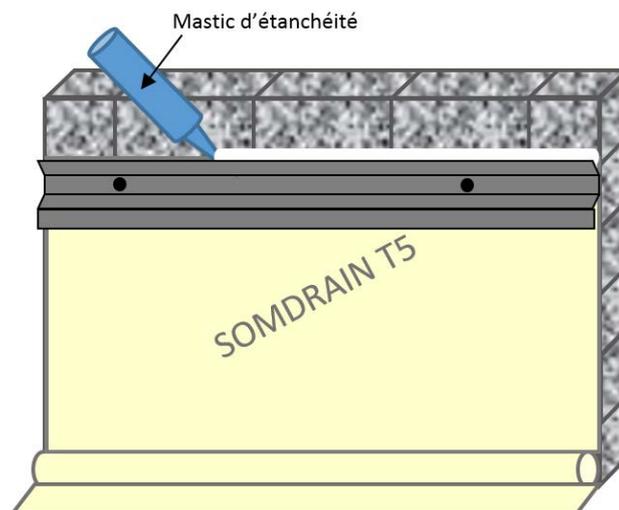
Mise en place du mastic d'étanchéité sur le solin
